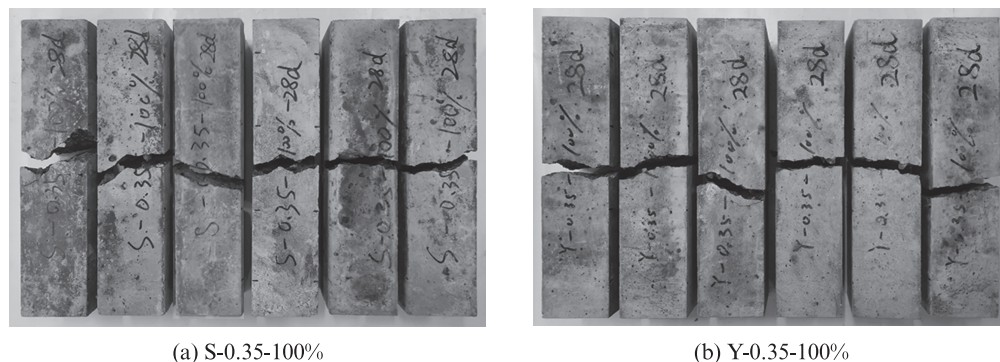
为煤矸石混凝土典型试件折断面形态。从图3(a)中可以看到,当煤矸石混凝土试件破坏时,由于
